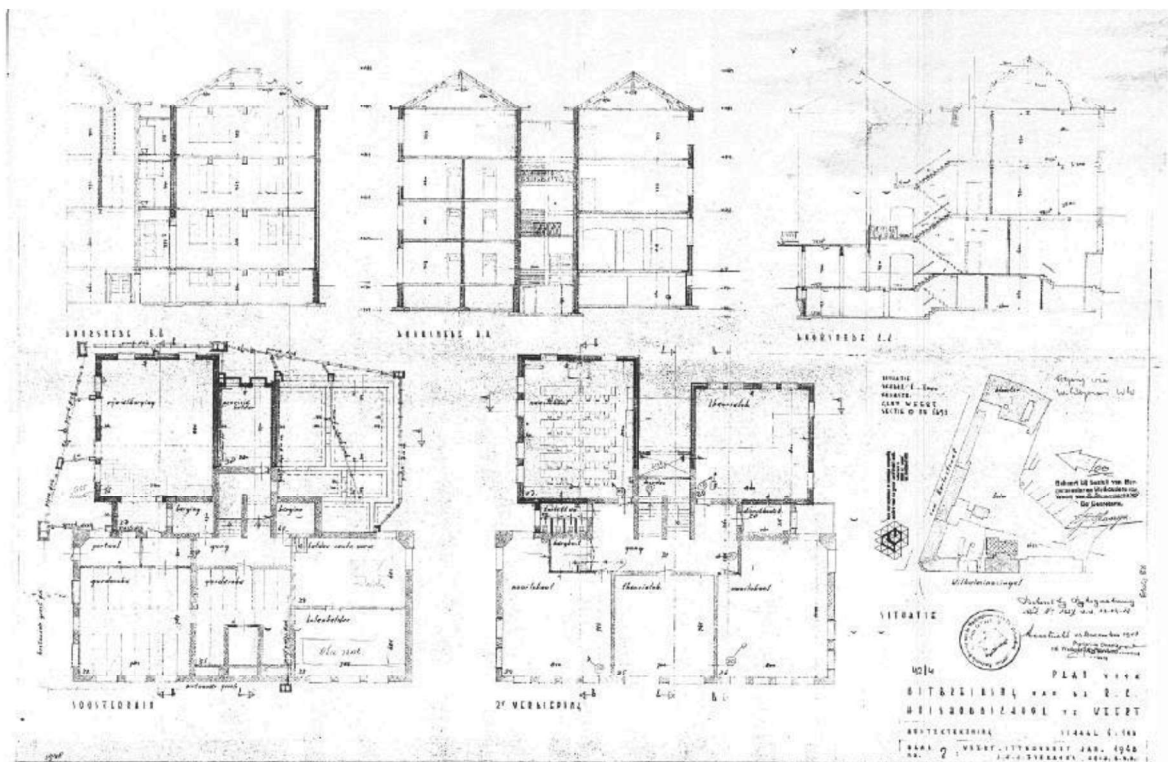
Bouwtekening voor de uitbreiding van de R.K. Huishoudschool, Wilhelminasingel 12. Gemaakt door: J.H.J. Everaers (1948)
